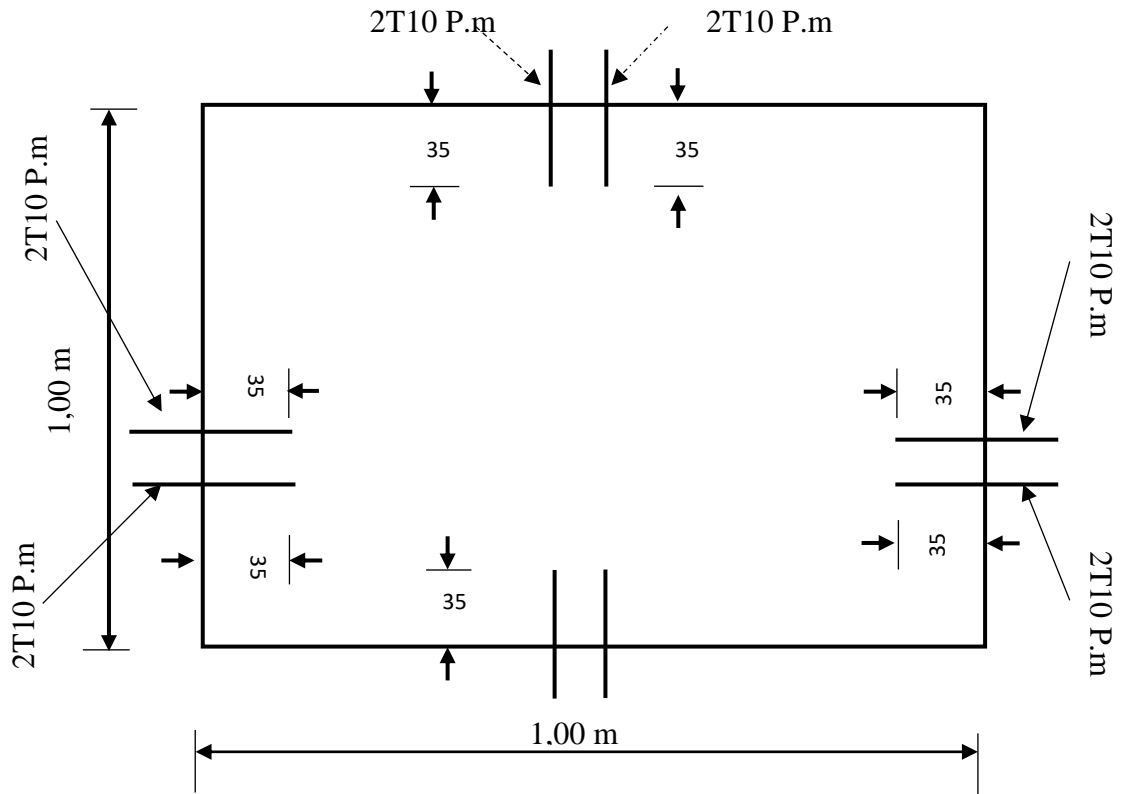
Ferrailage supérieur (sur appuis) du panneau de dalle plein
